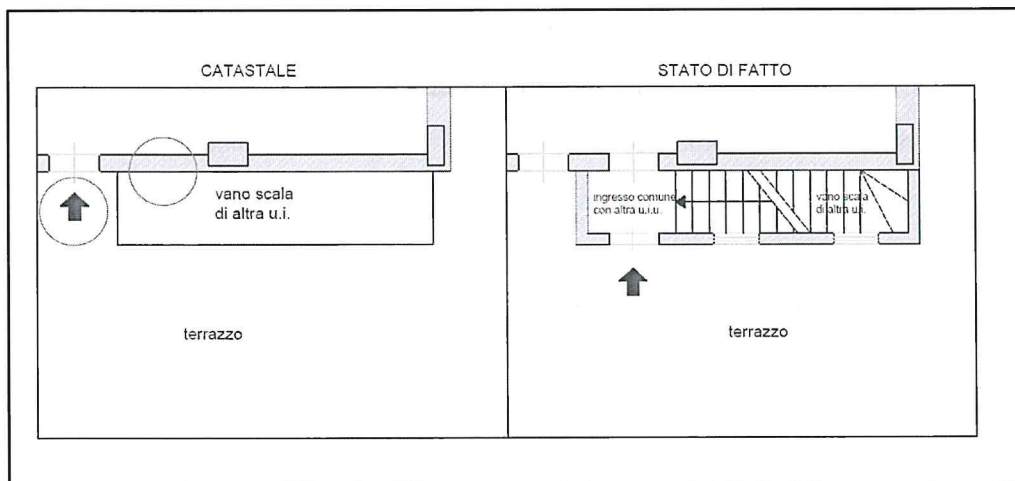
Raffronto stato di fatto e planimetria catastale, stralcio Allegato n. 4
